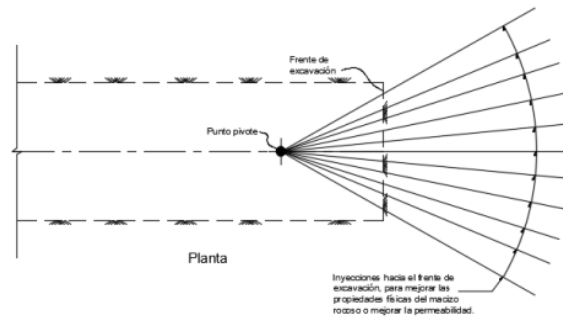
Planta detallando las inyecciones hacia adelante para tratar el frente de excavación de la galería piloto.
